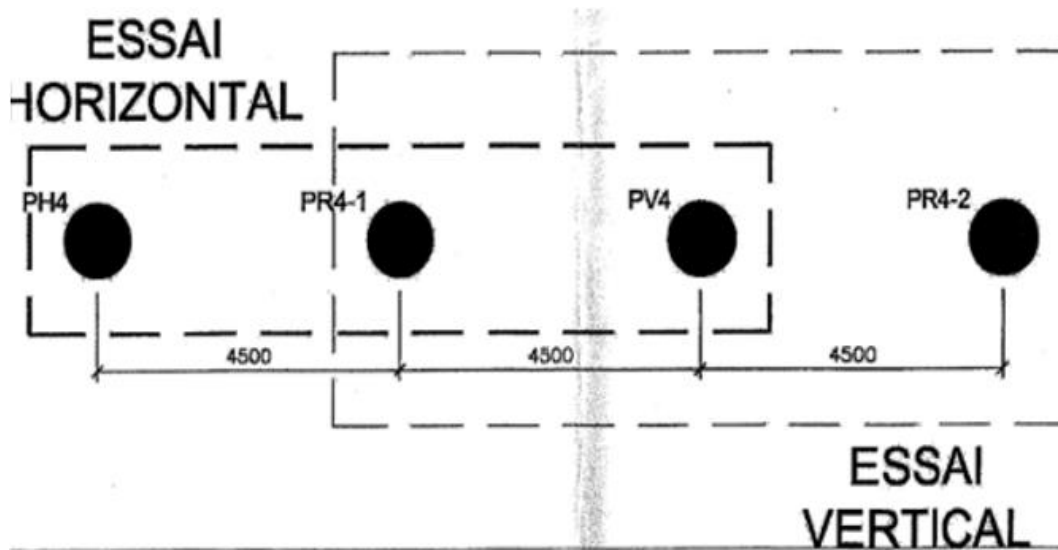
vue en plan de pieu d'essai PV4-PH4.
